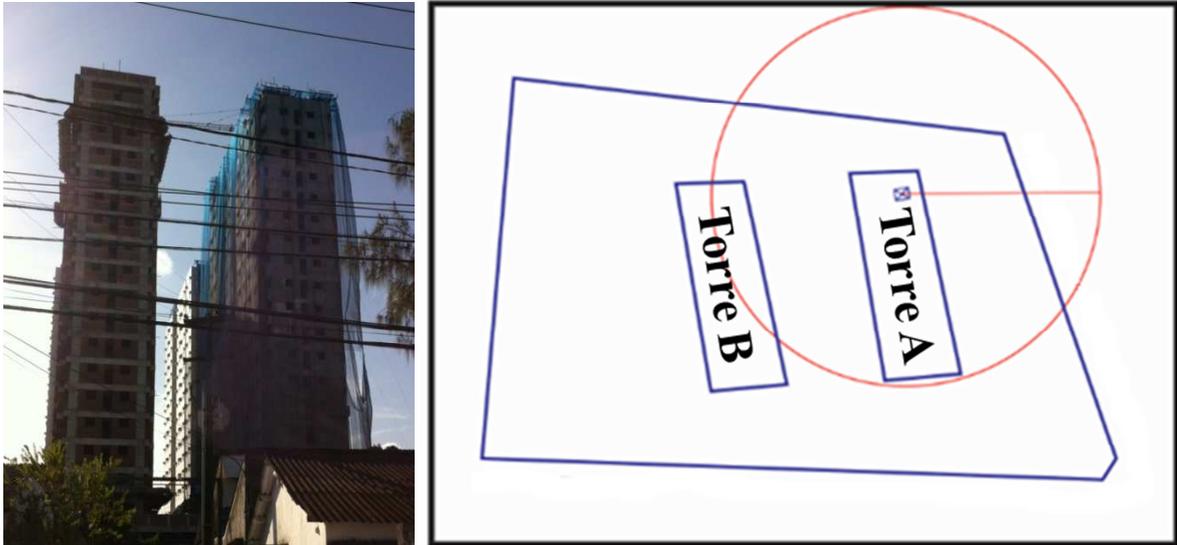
Planta de lay-out do canteiro do projeto VII.
